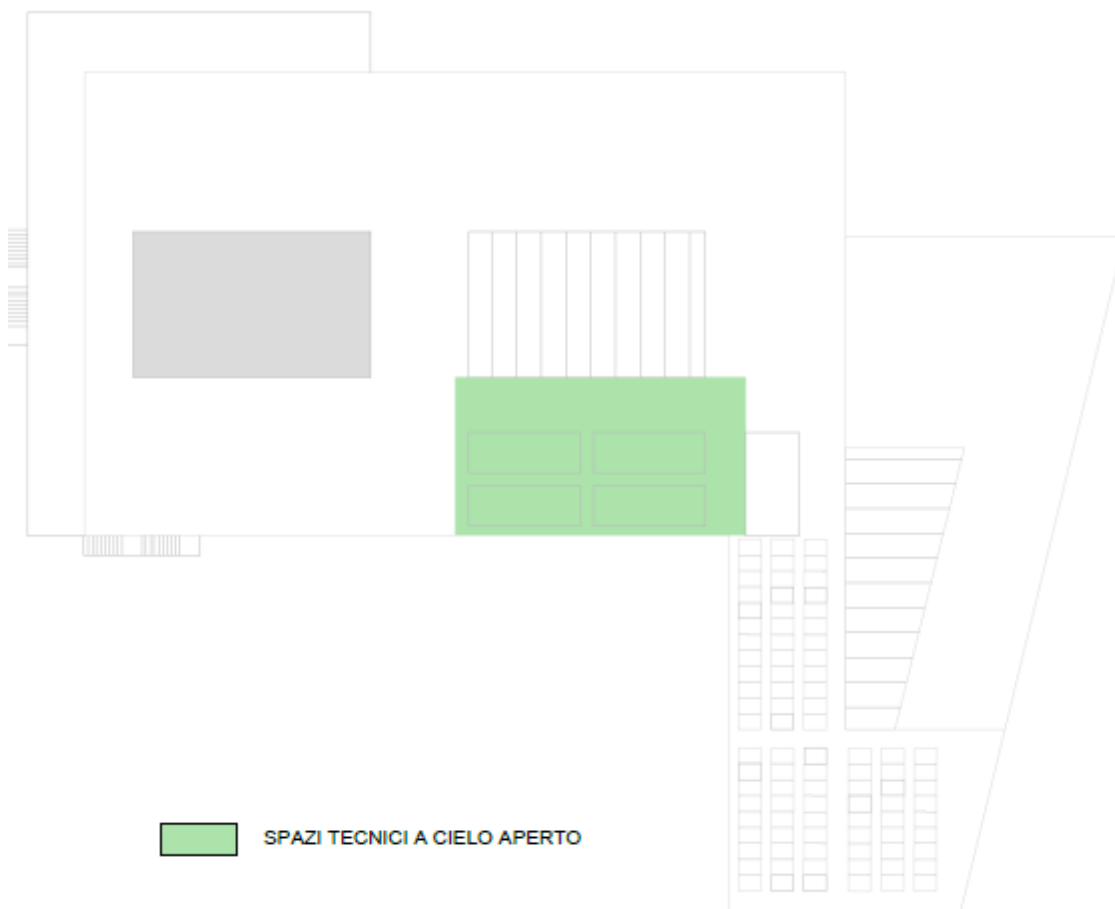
a - Estratto dalla tav. PU-2.5.02-00_Zonizzazione IM_P1-C allegata all'A.O. con riportata la pianta della copertura dell'edificio scolastico e la localizzazione degli impianti (in verde)
